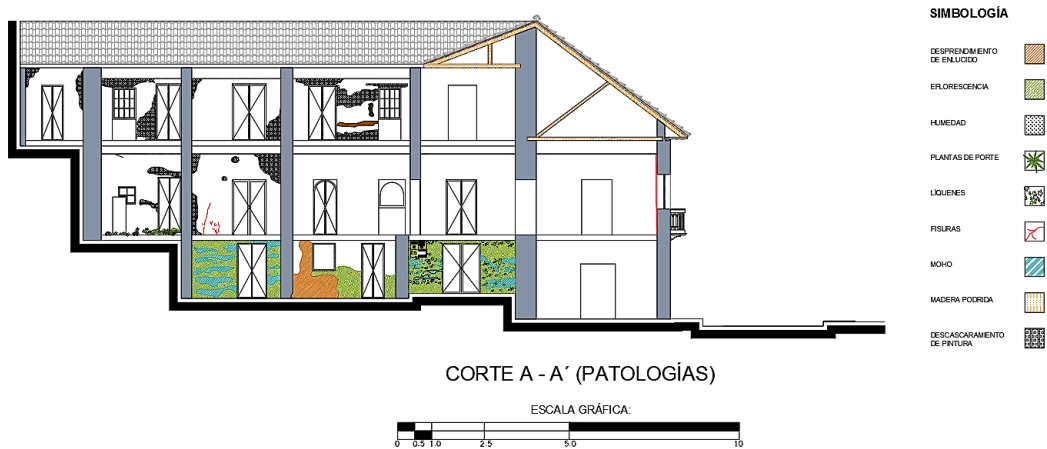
Patologías Corte A – A' • Fuente: Ilustración Propia
